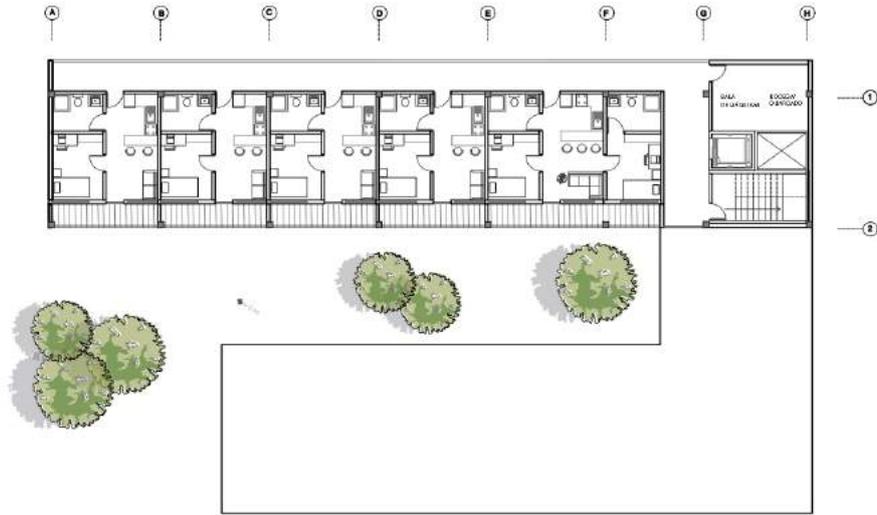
Planta N. +15,00 y N. +18,75. Elaboración propia
